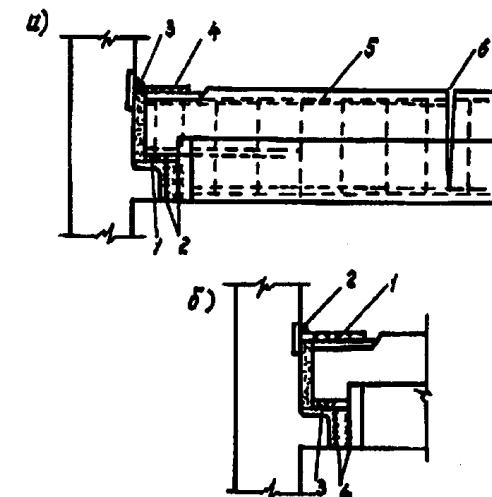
Неправильная (а) и правильная (б) последовательность наложения сварных швов в узле сопряжения колонны и ригеля в рамно-связевых каркасах серии ИИ-04:
